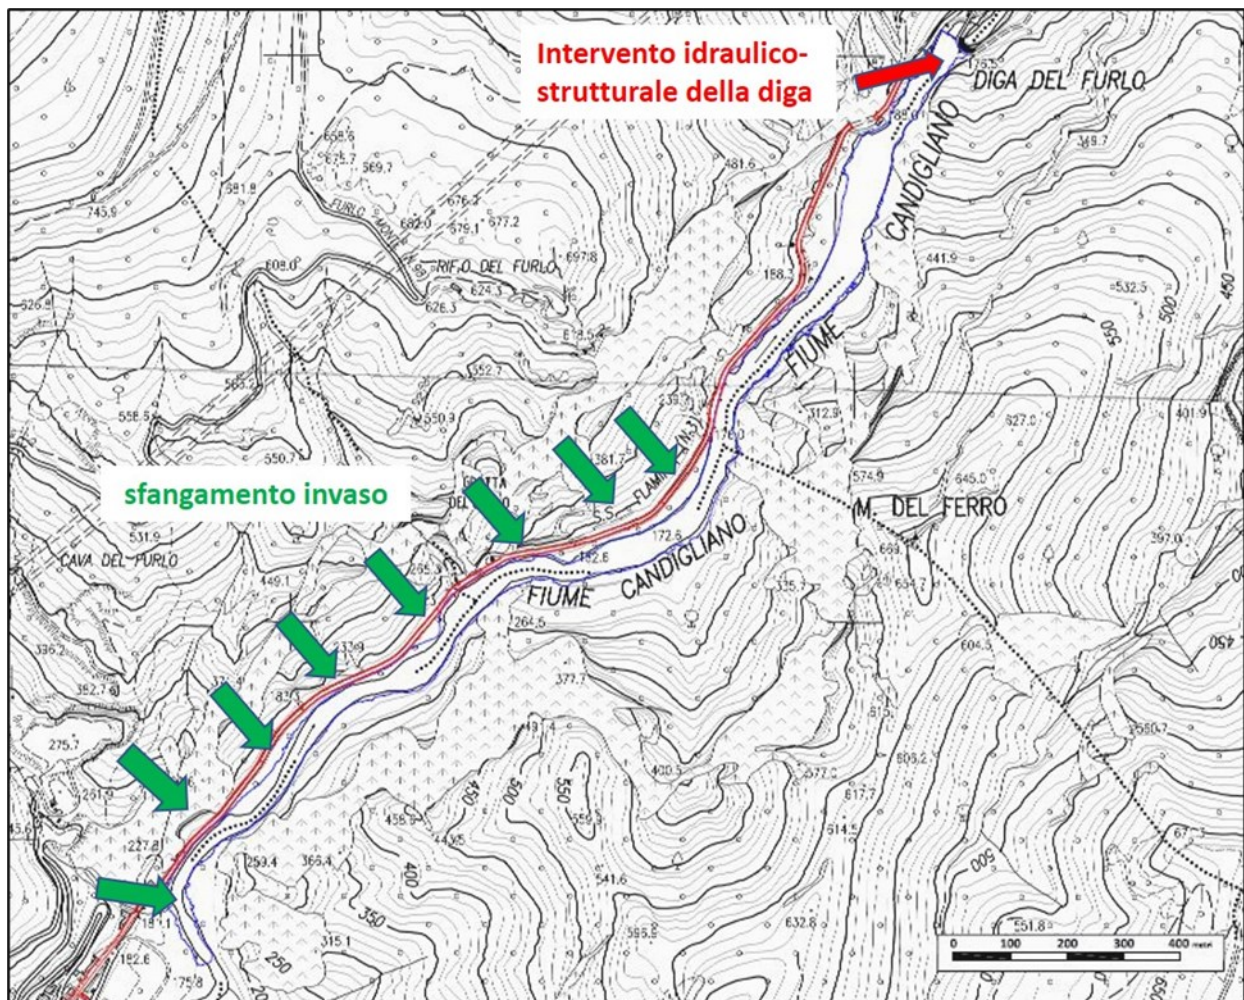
Rappresentazione schematica delle aree del bacino interessate dalle attività di sfangamento e di adeguamento idraulico strutturale della diga
